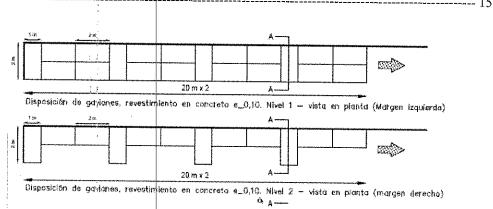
Disposición en planta niveles de muros en gavión margen izquierda. Documento Tecnico, Cenit 2020.
